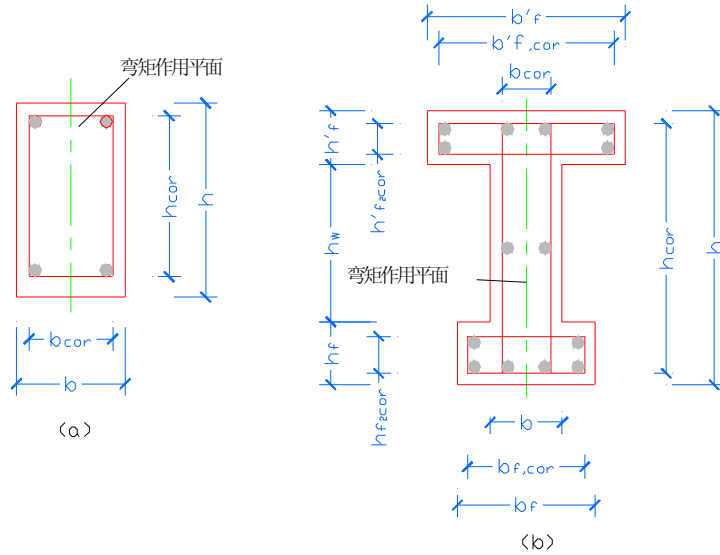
钢筋轻骨料混凝土受扭构件截面尺寸
